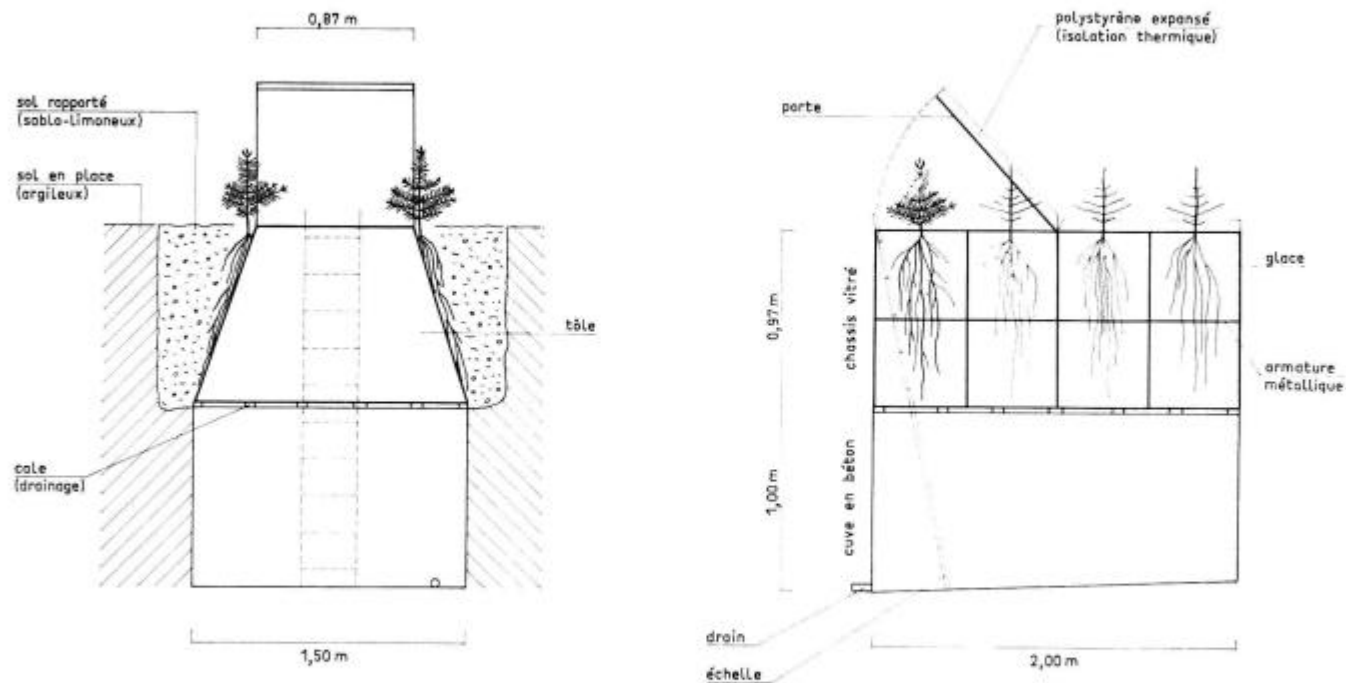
Croquis de la chambre d'observations souterraine, à parois vitrées (Sketch of the underground root - observation room)
